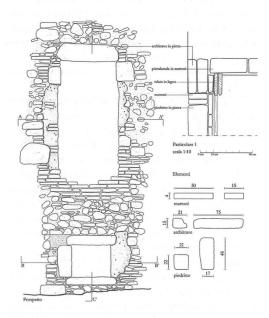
Albañilería mixta. Borgo Faraone (Te), casa campesina, detalles
